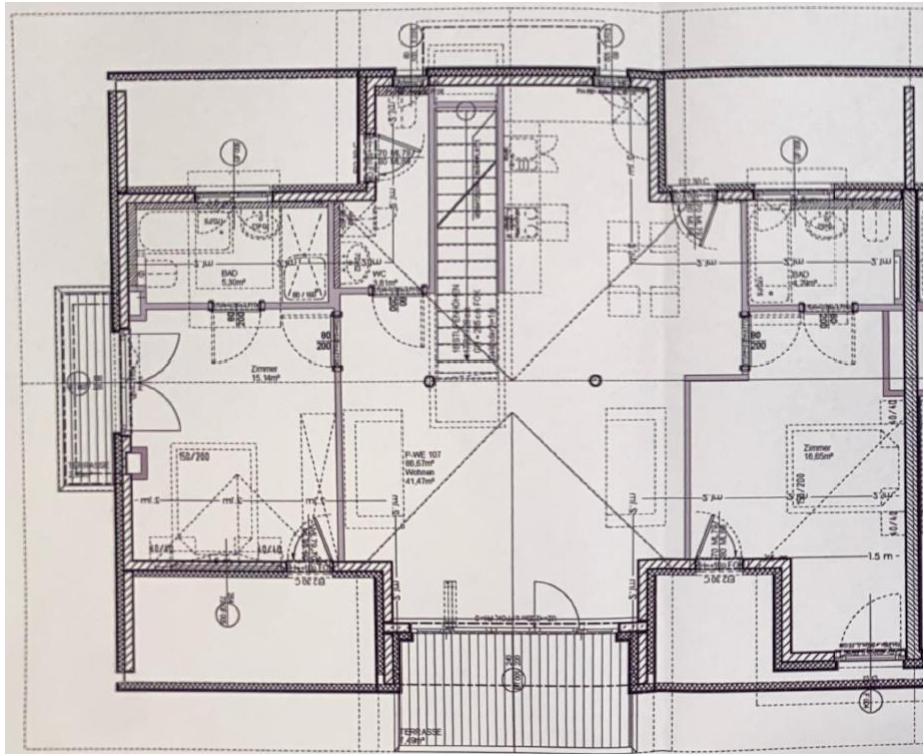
Grundriss Wohnung Top 7 - Haus Manuela
